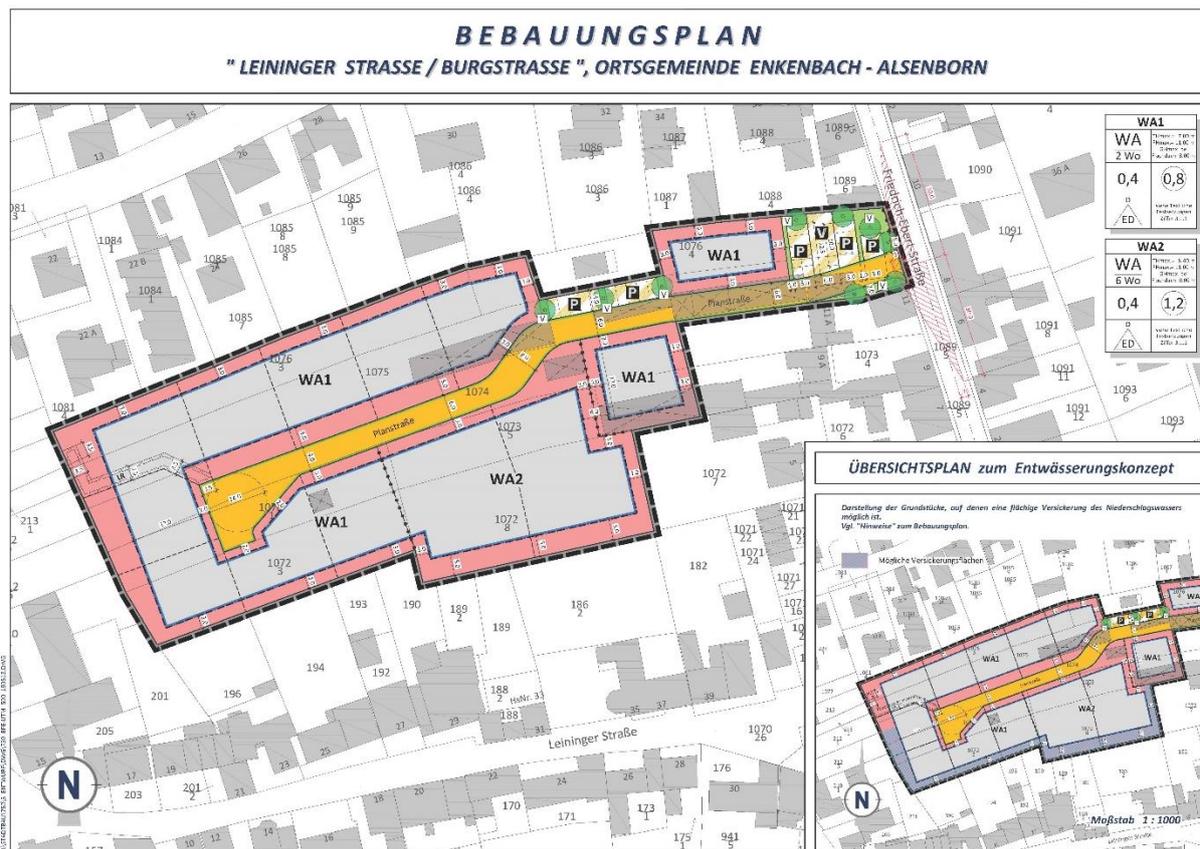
Bebauungsplan „Leiningen Straße/Burgstraße“
